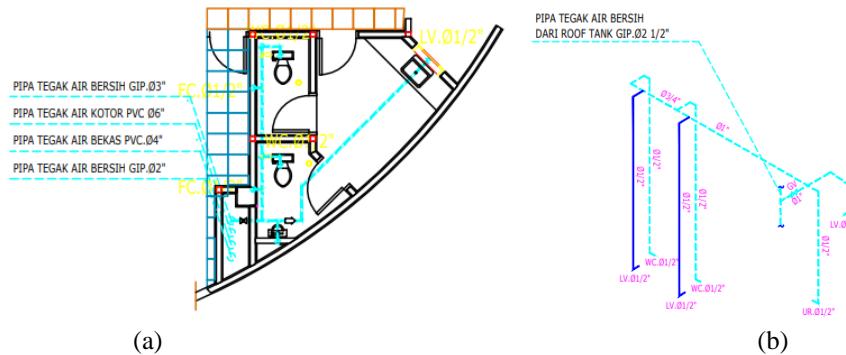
(a) Denah instalasi air bersih lantai *basement*, (b) Isometrik instalasi air bersih lantai *basement
